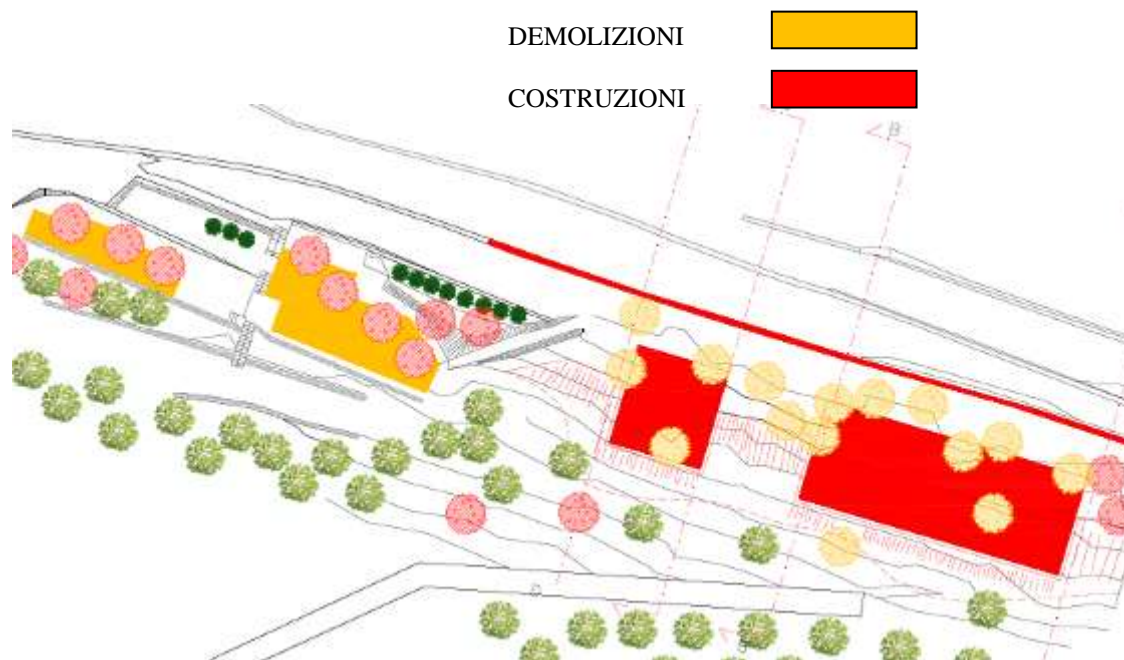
stralcio da Tavola raffronto del progetto Arch. Galletto
